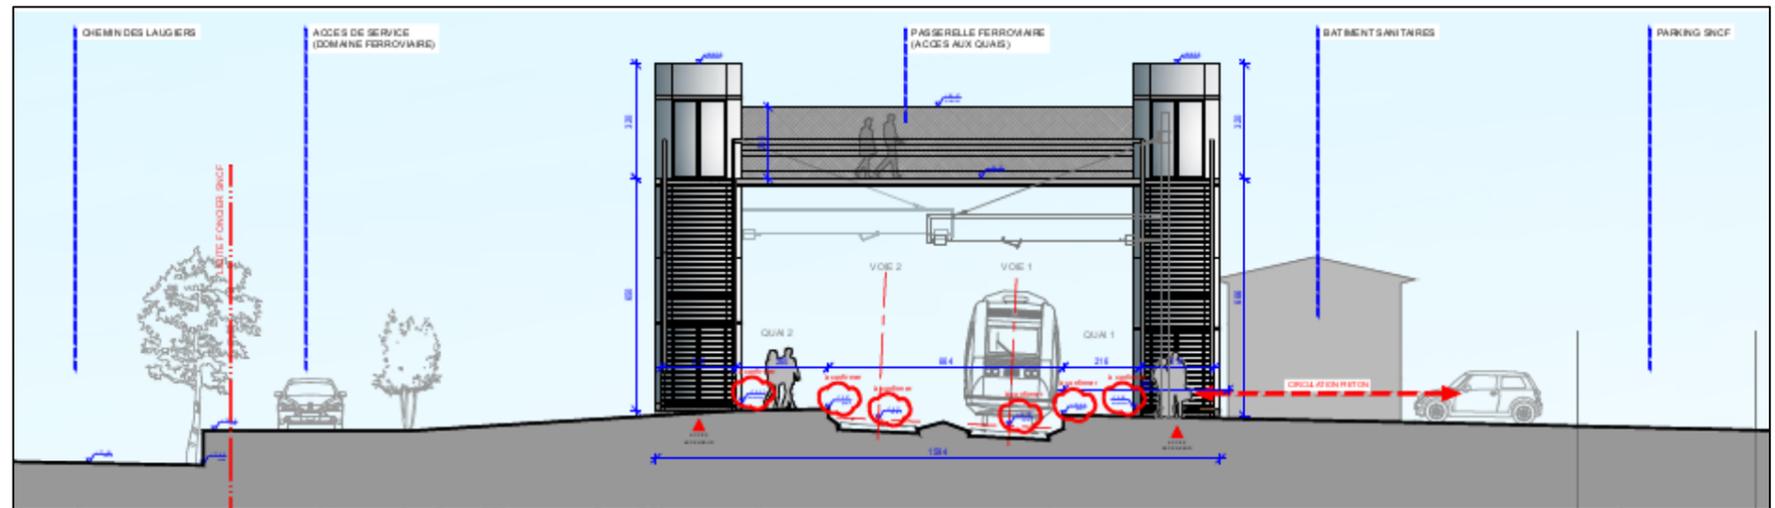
Solliès-Pont - coupe sur site (AREP, 2021)
